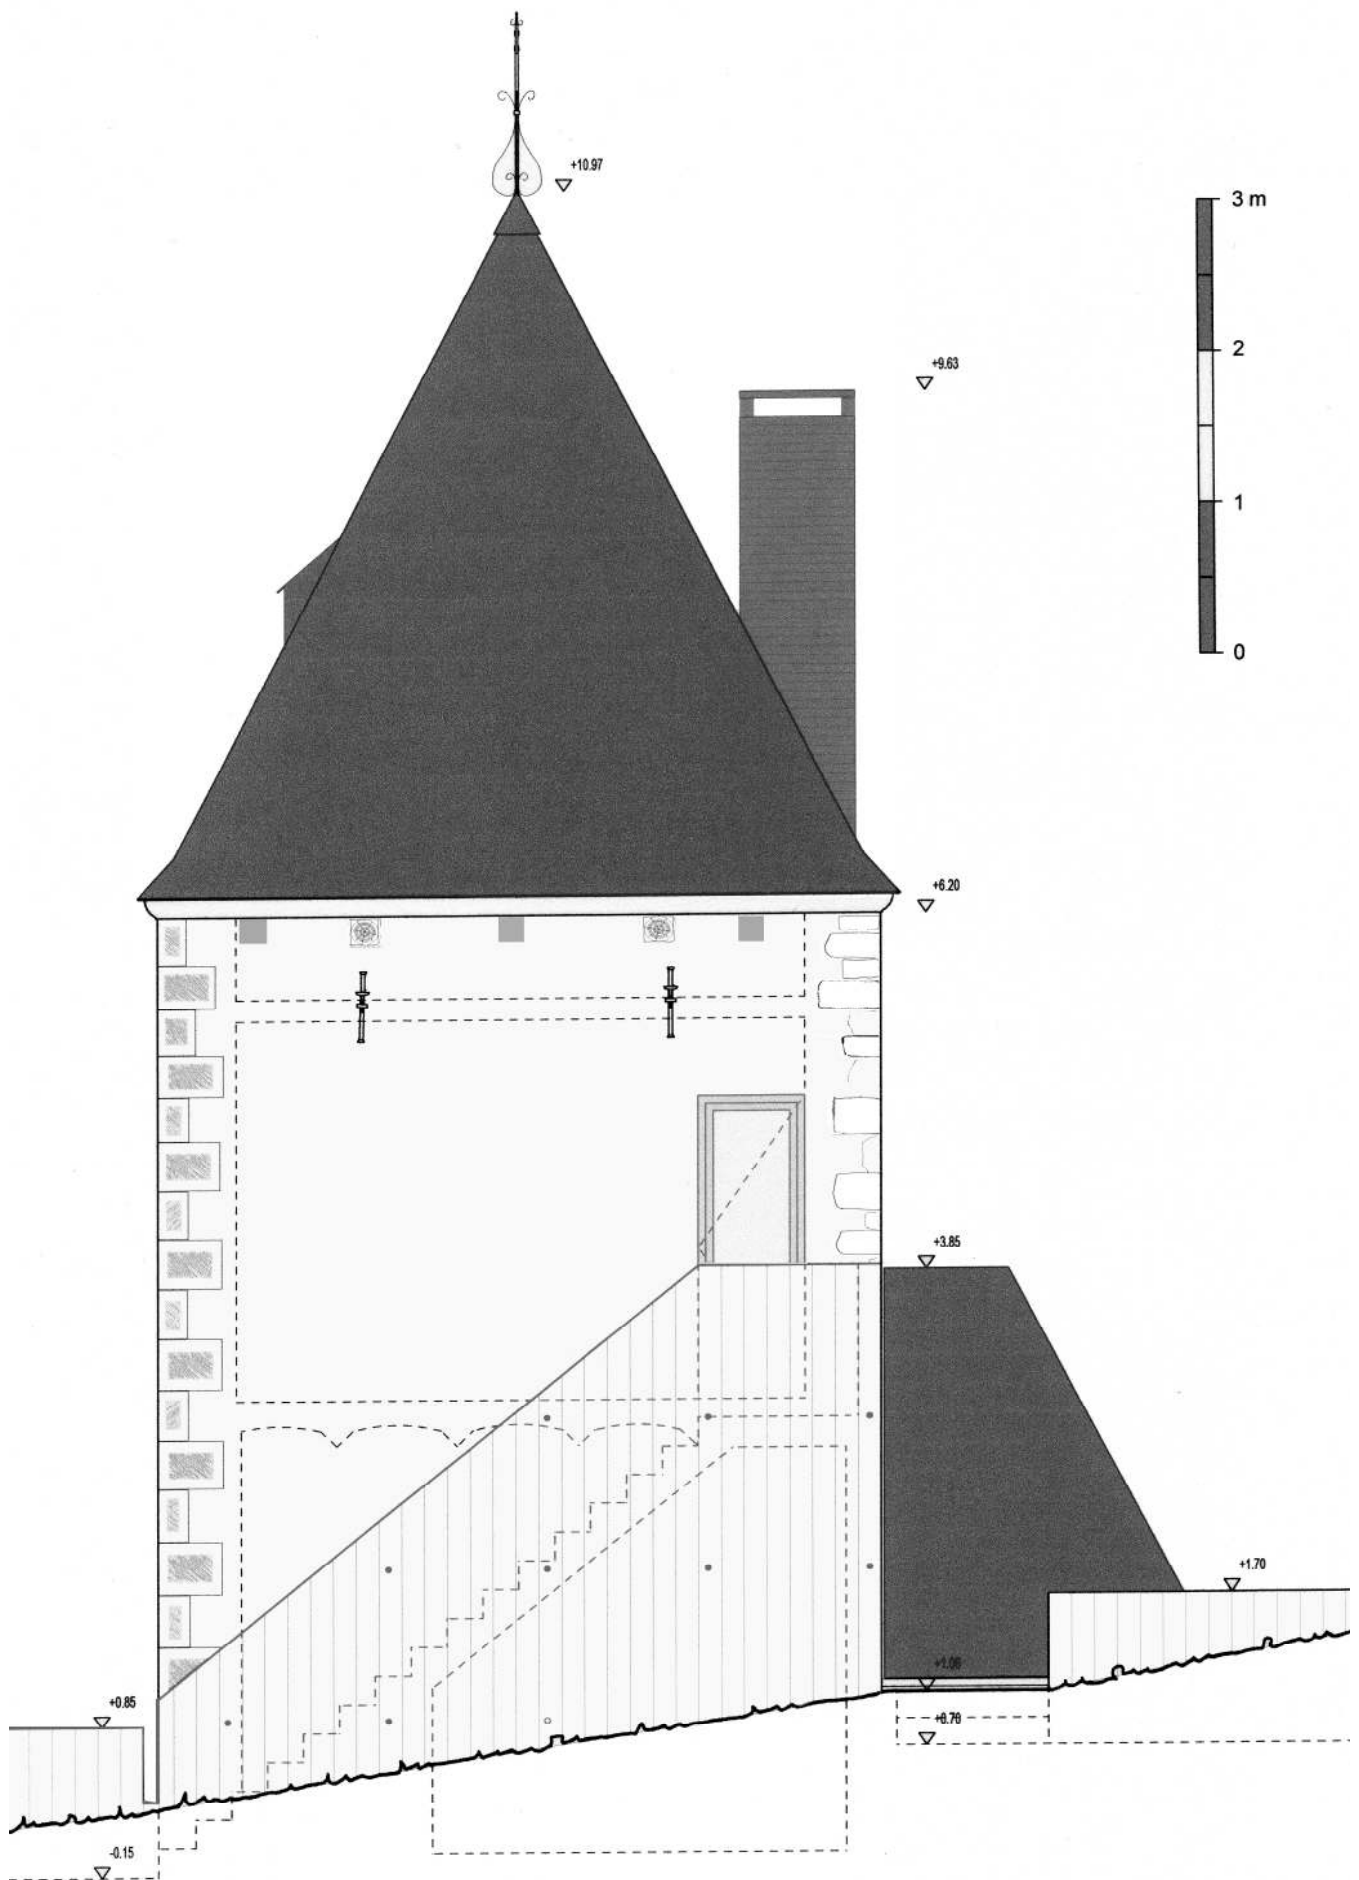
Pavillon. Elévation SO. Ech. 1/50°. Situation projetée. IG 2008.
